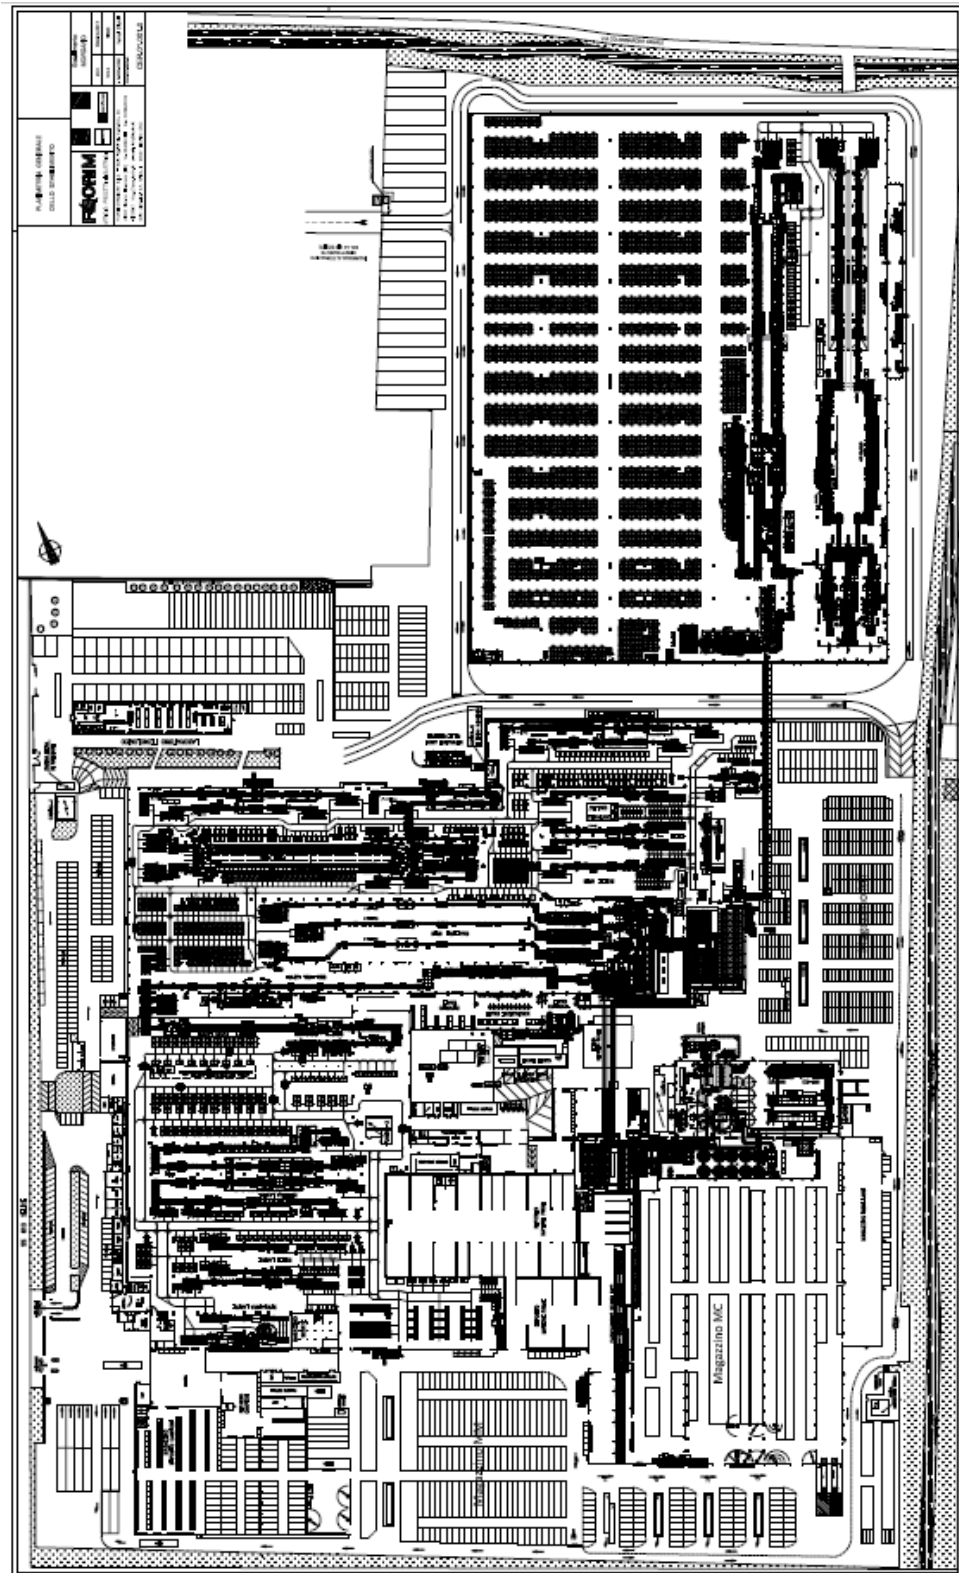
b - Pianta dello stabilimento – STATO di FATTO
